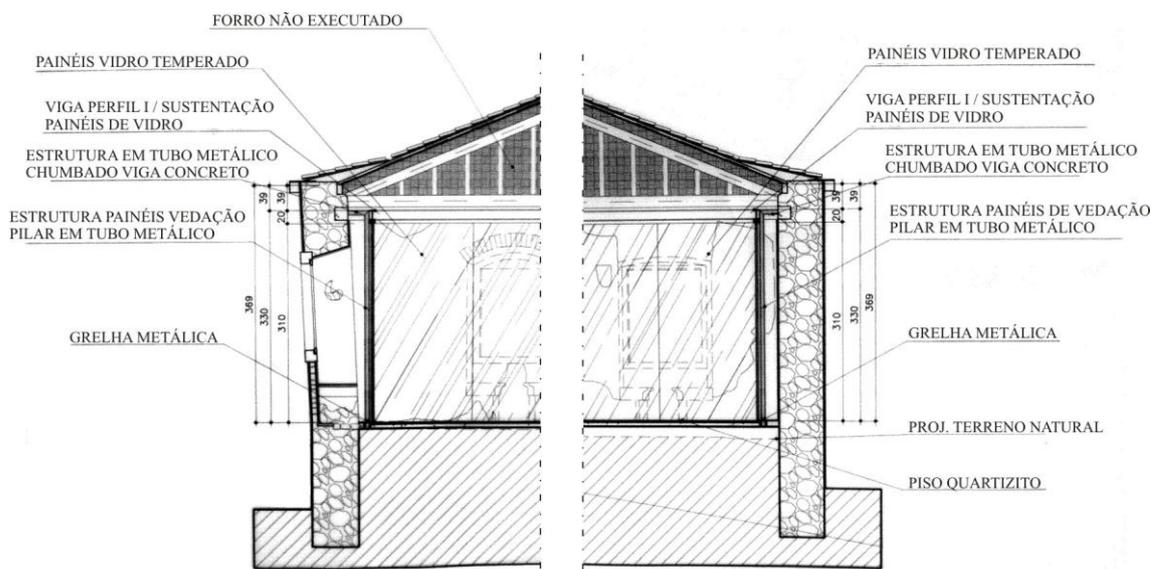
Foto digital de cortes do projeto executivo - apoio da cobertura.
